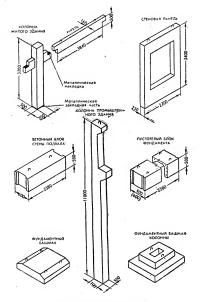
Сборные бетонные и железобетонные цетали стен, каркаса и фундаментов.
